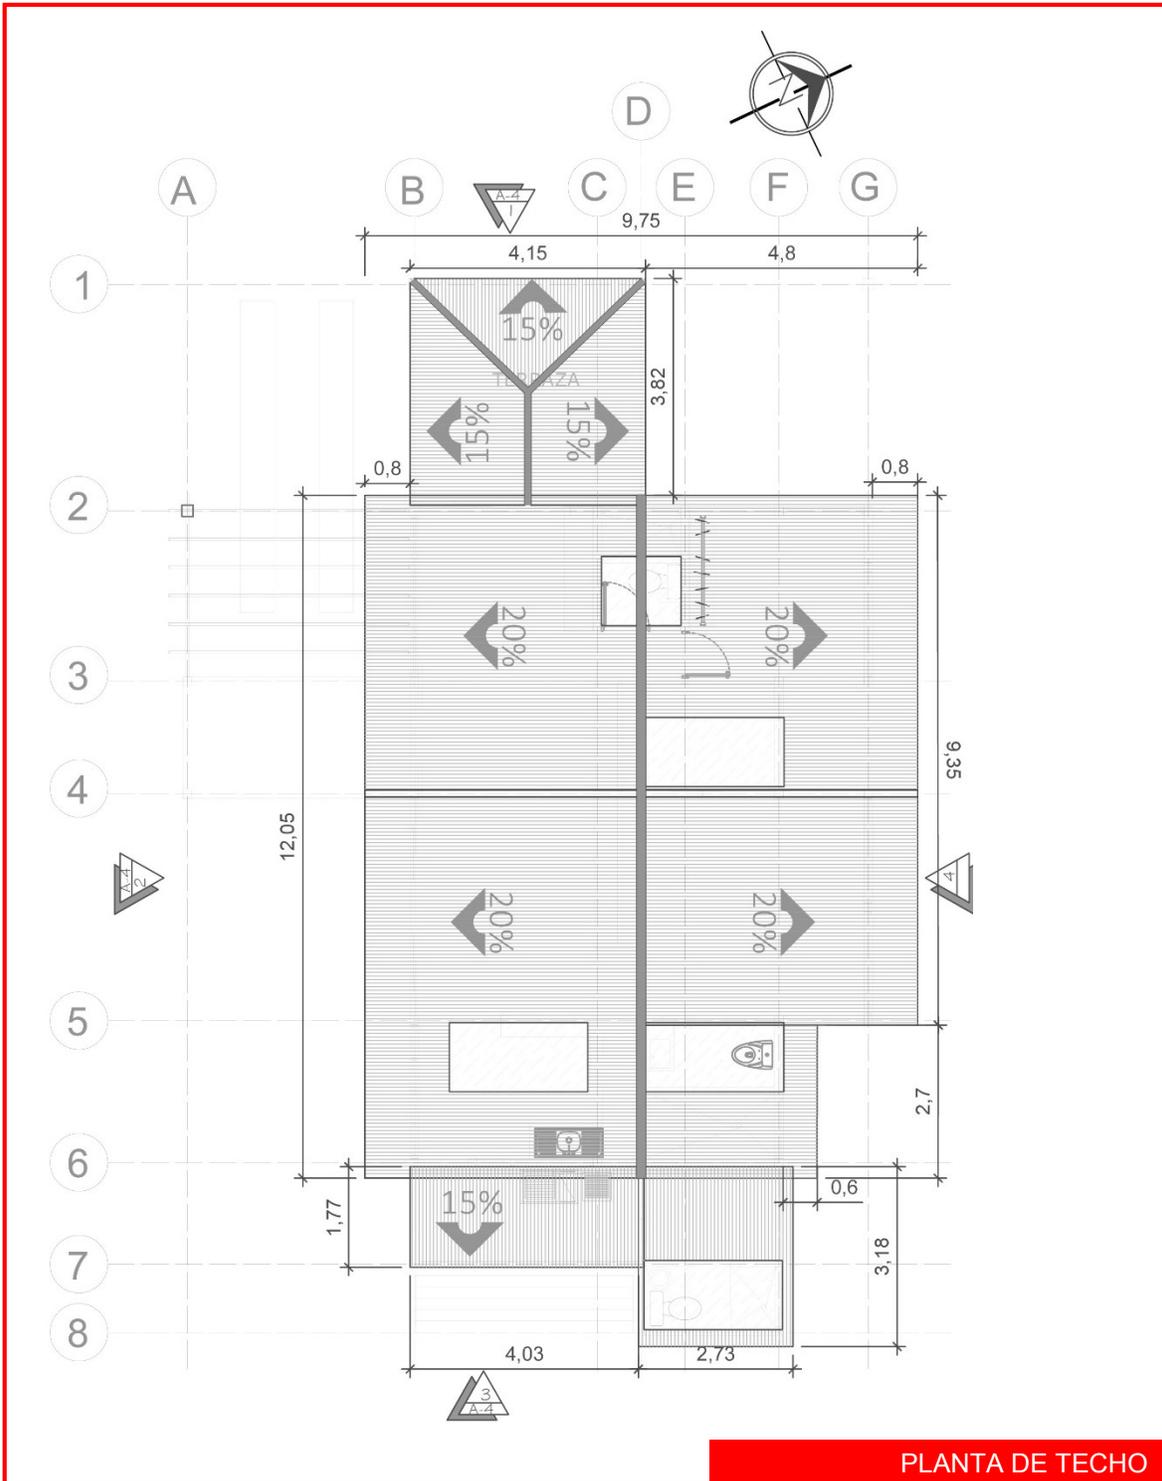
Planta Arq. de Techo. Fuente: Autor. Programa: AutoCad
